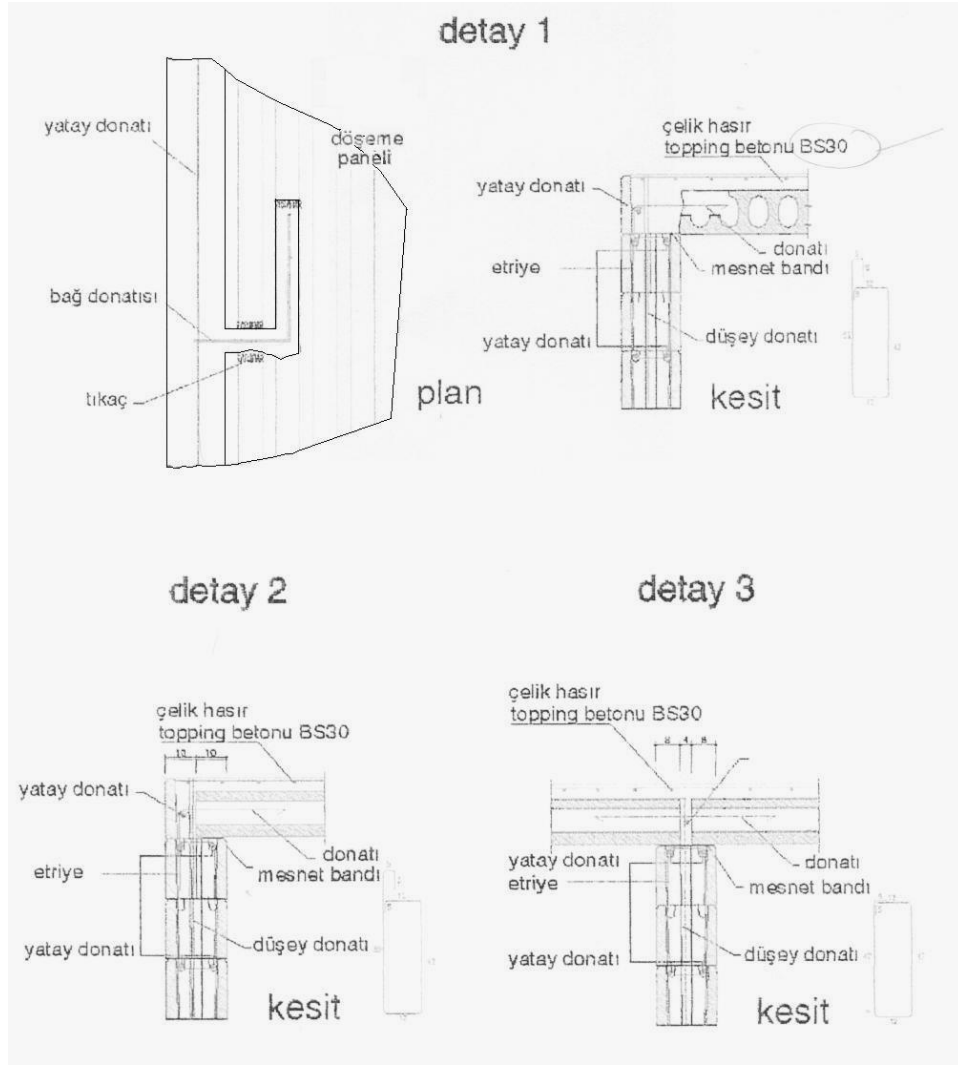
YMPK Sistemi Öngerilmeli Beton Döşeme Paneli [16]
